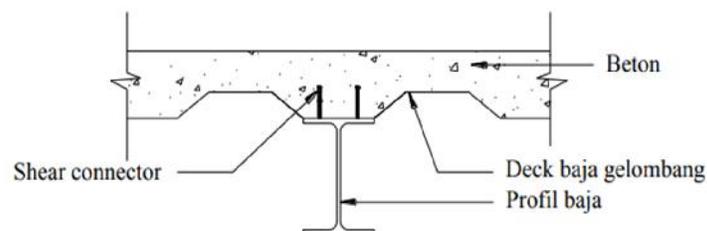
Balok baja tanpa diselubungi beton (Setiawan, 2008)
